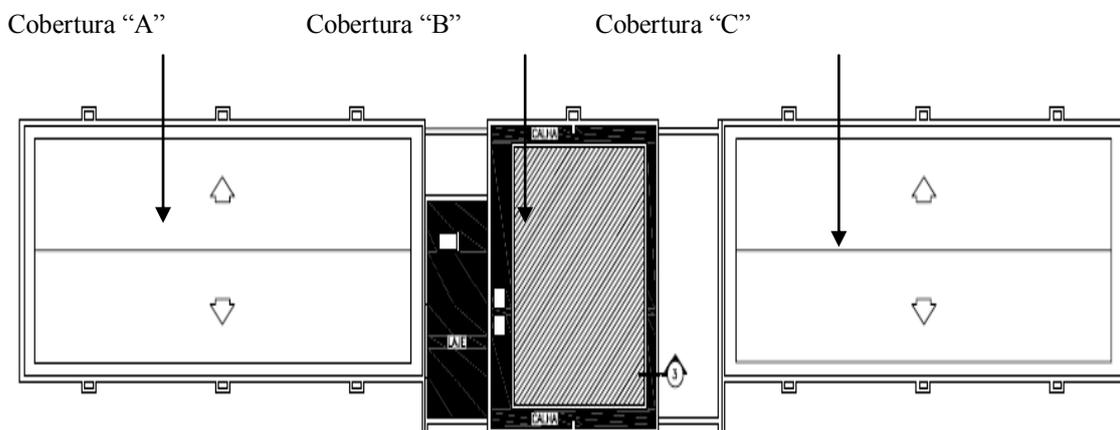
Planta da cobertura do bloco “O” do Campus do Gragoatá, com área de 900,00m², constituída de 3 alas com 3 telhados, com suas respectivas águas ou caimentos e 14 captadores de águas (7 em cada fachada longitudinal), vindas das calhas de concreto
